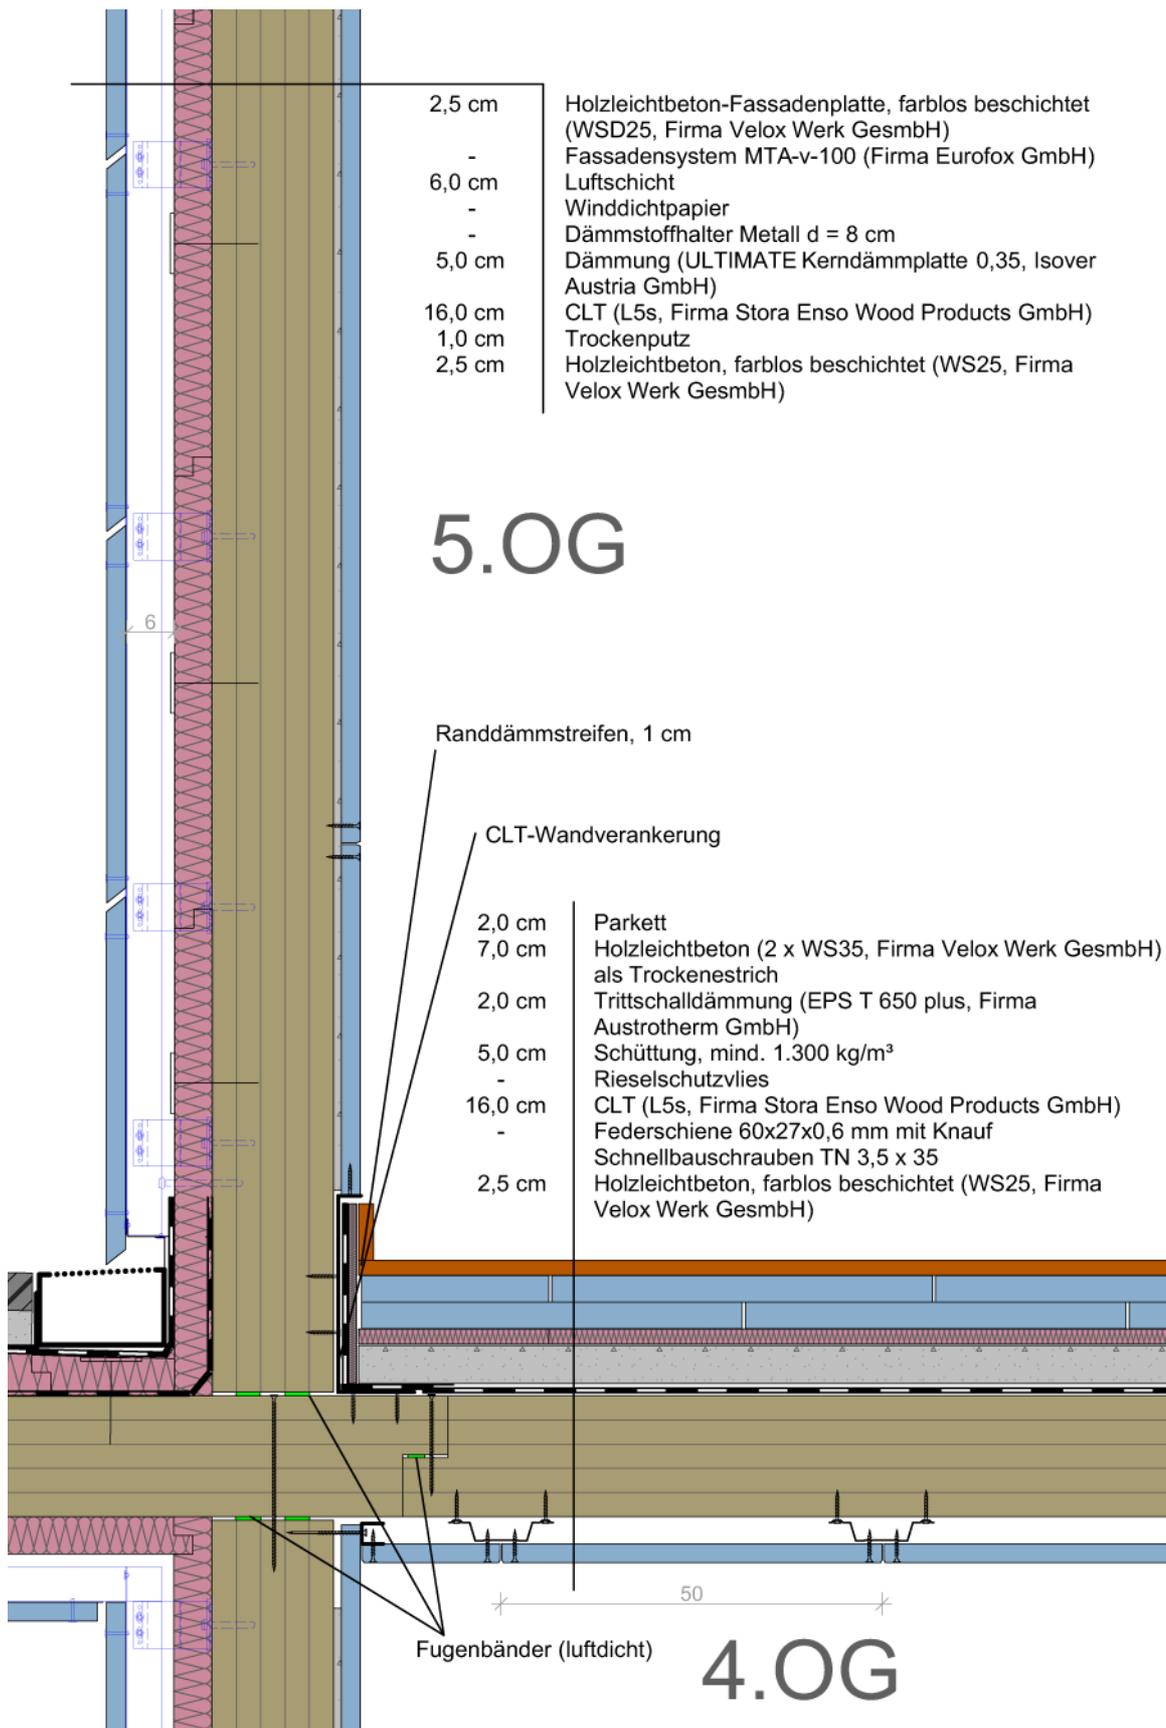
Detail 1:10 - Anschluss Außenwand-Geschoßdecke-Balkon
